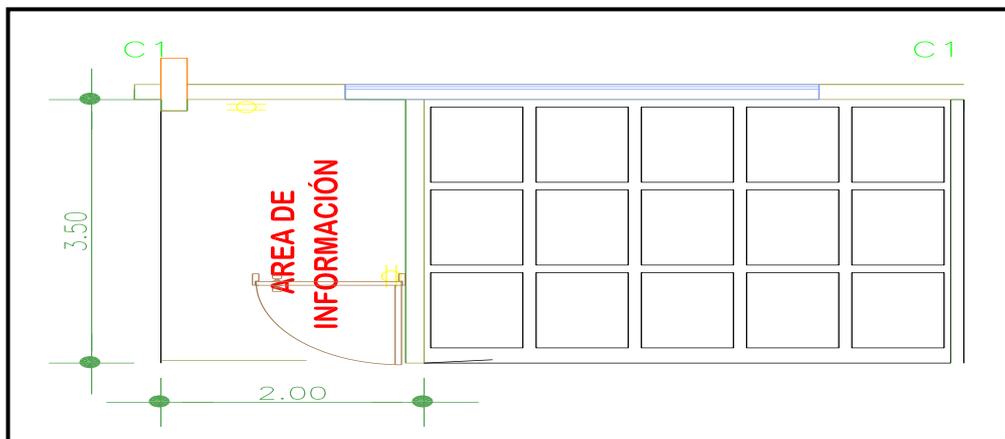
Vista arquitectónica general del área de información de la planta de reciclaje
